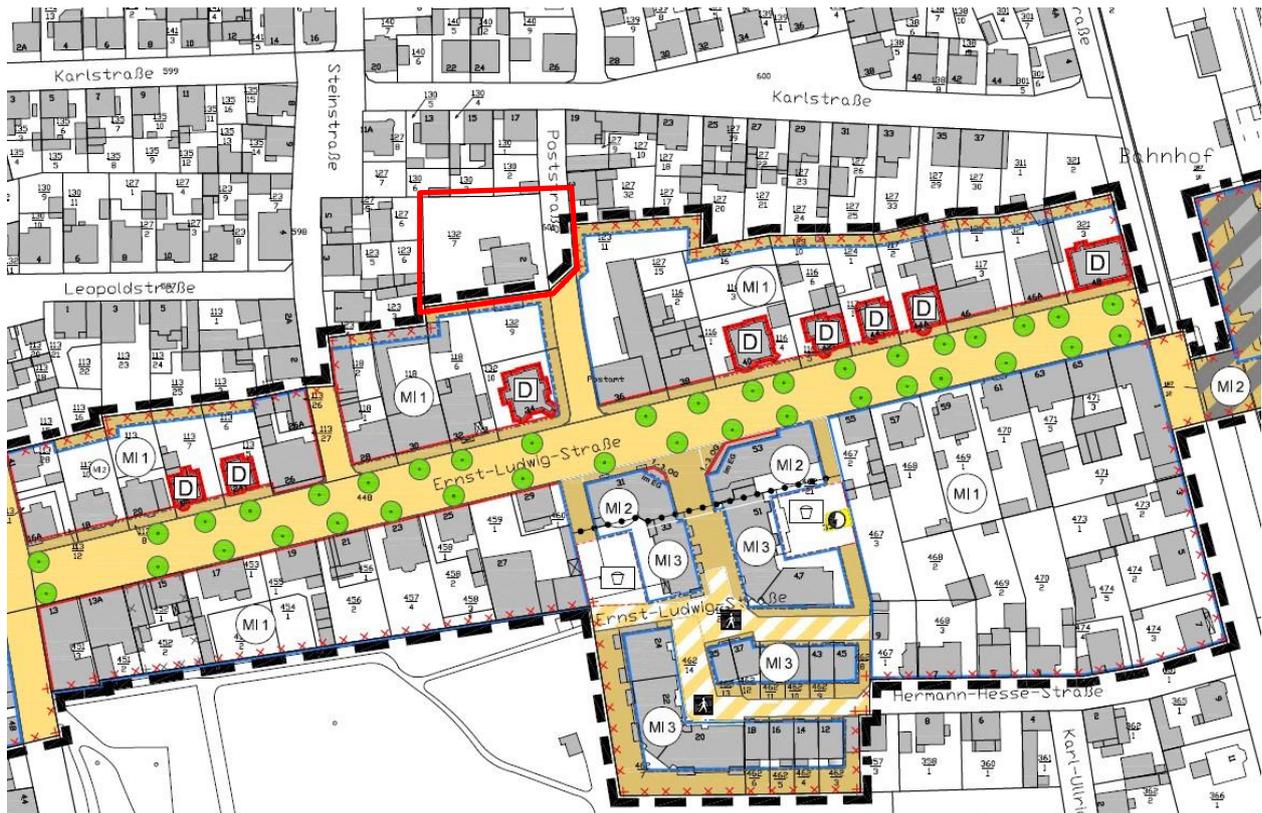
Ausschnitt aus dem einfachen Bebauungsplan „Ernst-Ludwig-Straße“ mit Kennzeichnung des durch den neuen Bebauungsplan betroffenen Bereichs (unmaßstäblich; Bildquelle: Geografisches Informationssystem (Bürger GIS) des Landkreises Bergstraße, Internetabruf am 02.04.2020 unter <https://buergergis.kreis-bergstrasse.de>)
